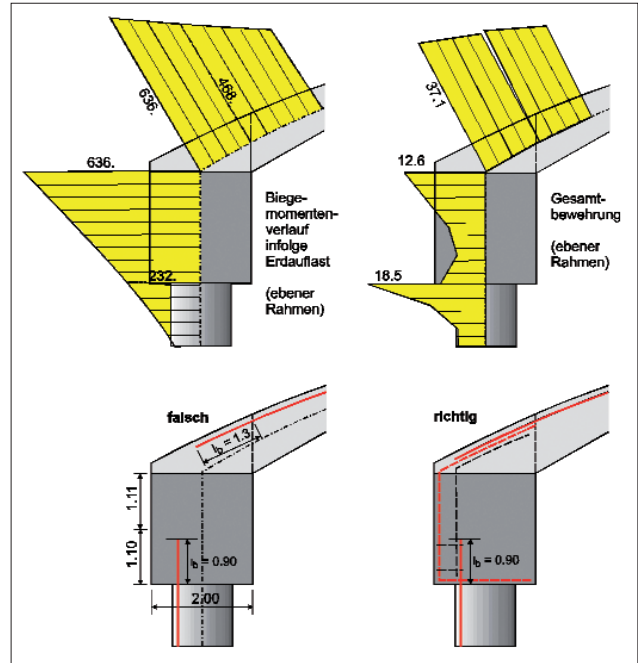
Biegemomentenverlauf, statisch erforderliche Bewehrungsmenge und Bewehrungsführung im Pfahlkopfbereich
